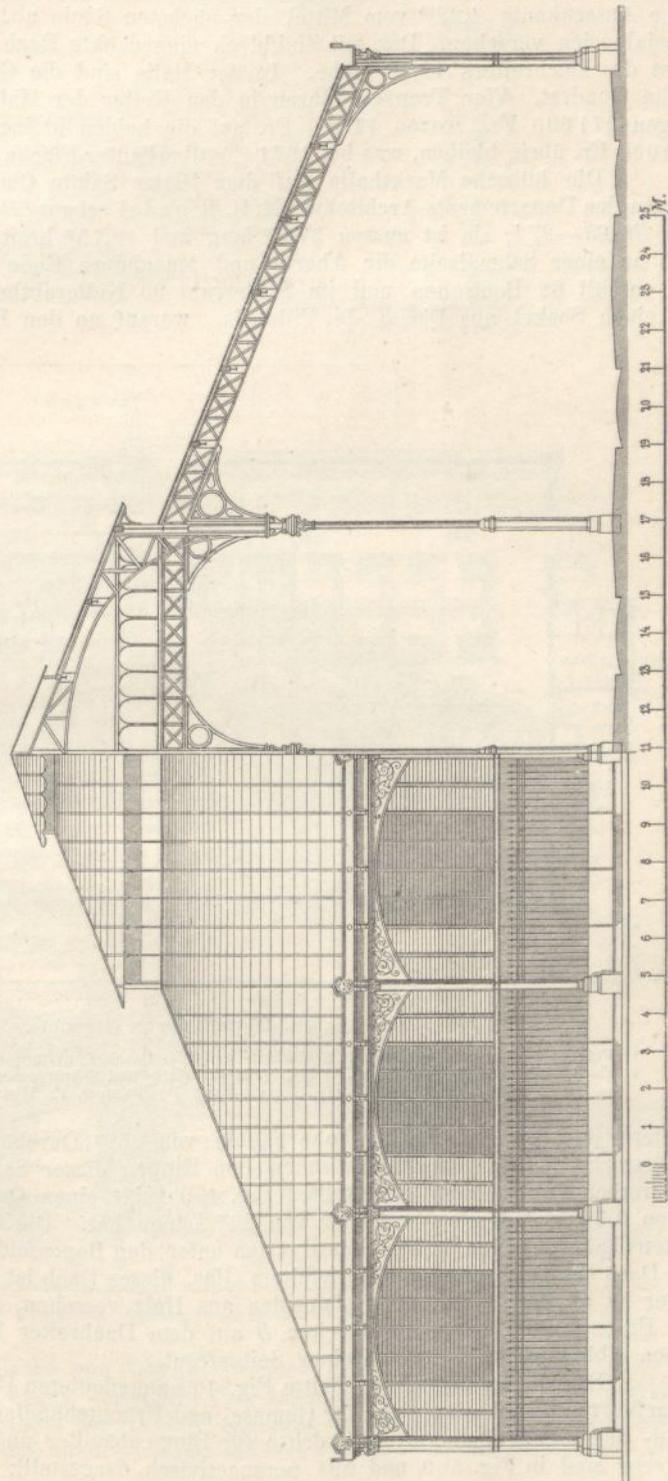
Detail-Markthalle an der Avenue des Ternes zu Paris.
